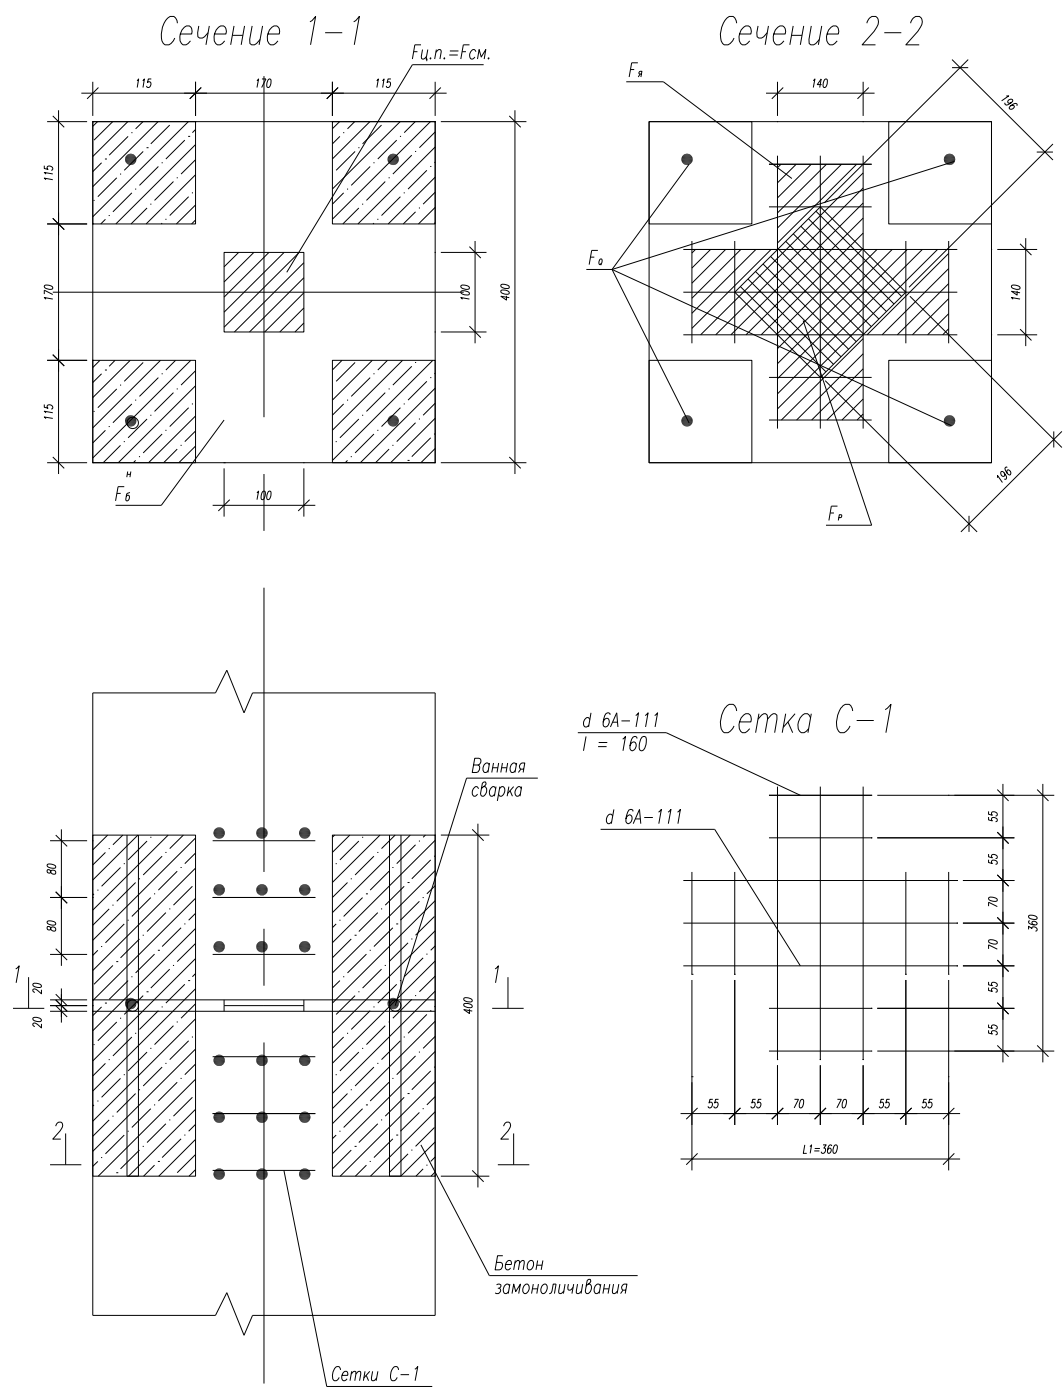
Конструкция стыка колонн с ванной сваркой выпусков арматуры
